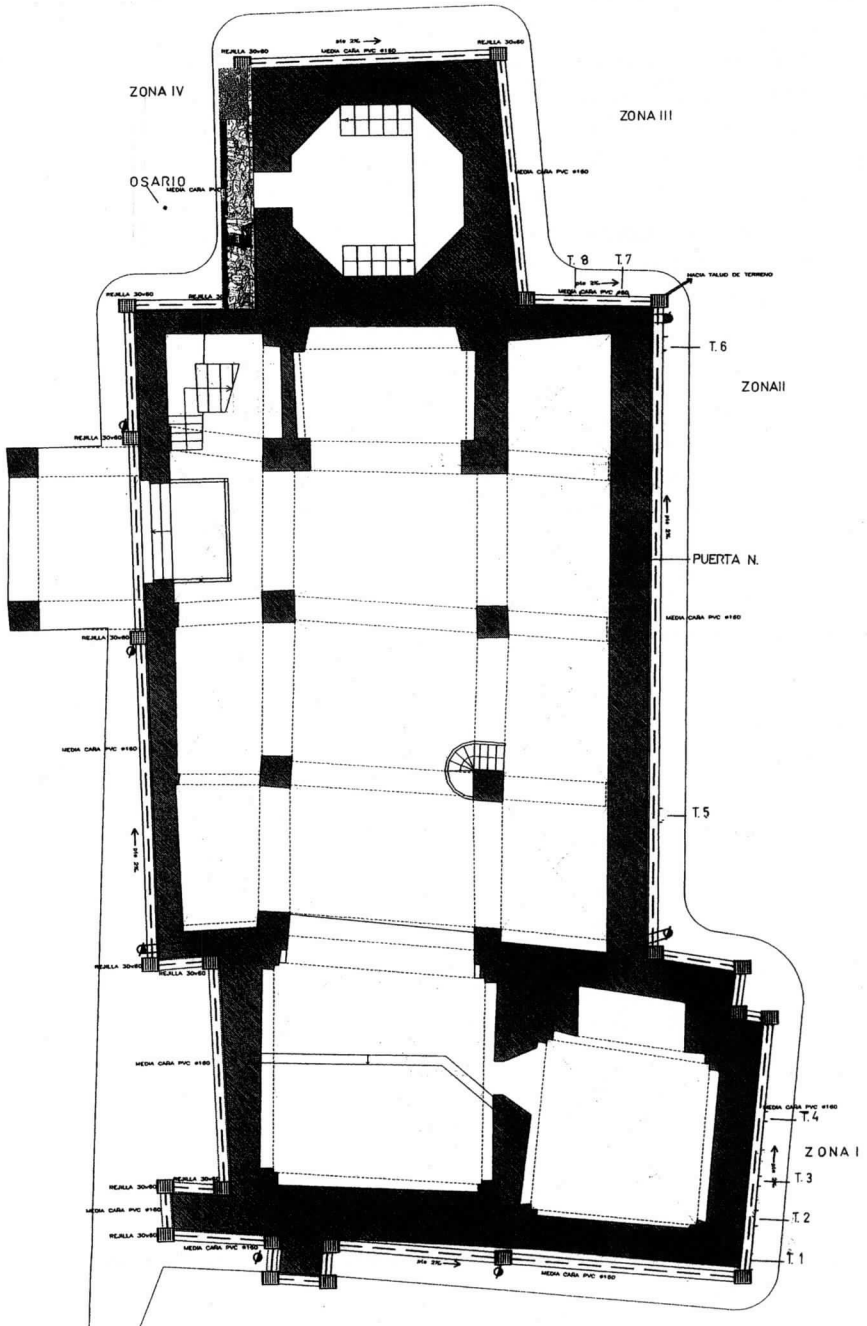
Zonas de inhumación sobre plano planta con dren perimetral
